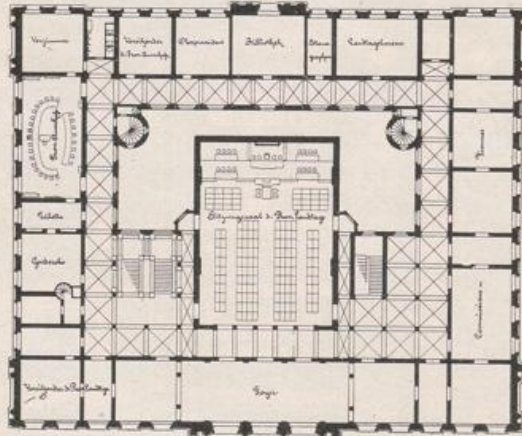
Grundriss des 1. Stockwerks. 1 : 800.
